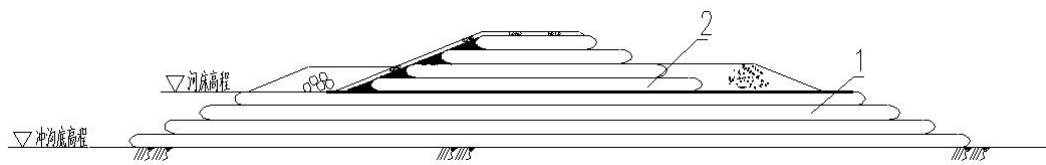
平衡袋位置围堰横剖面示意图
